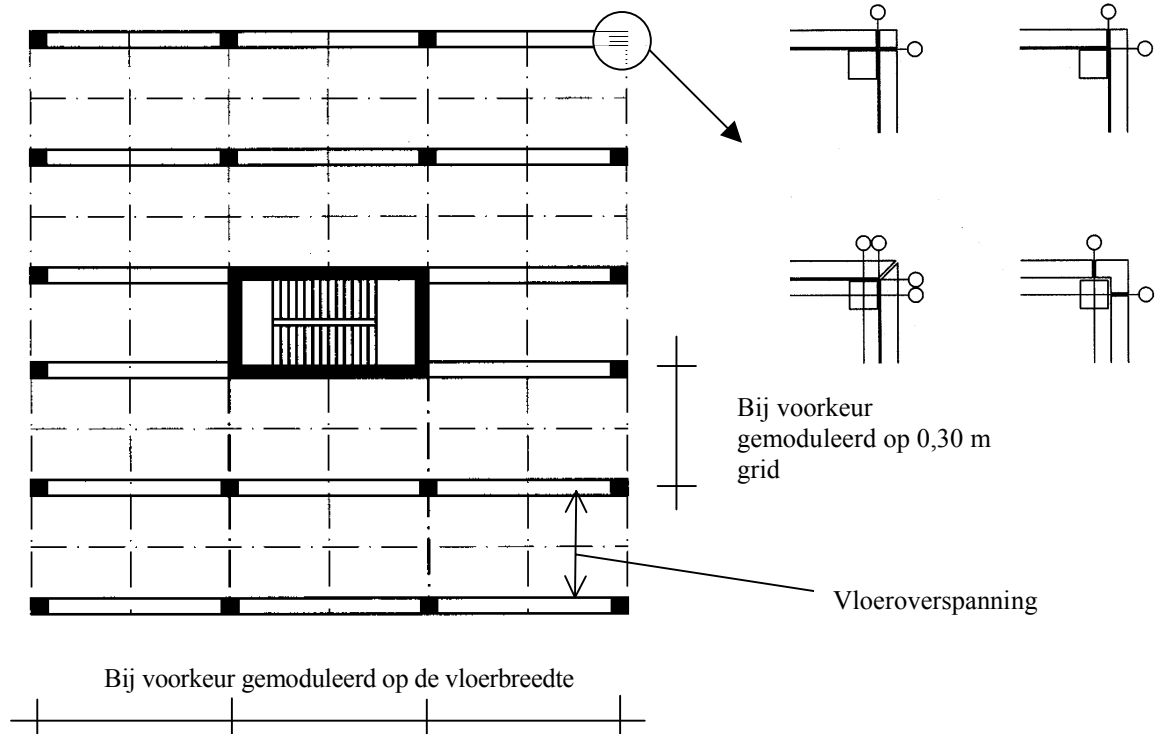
Voorbeeld van een modulair systeem voor prefabconstructies
